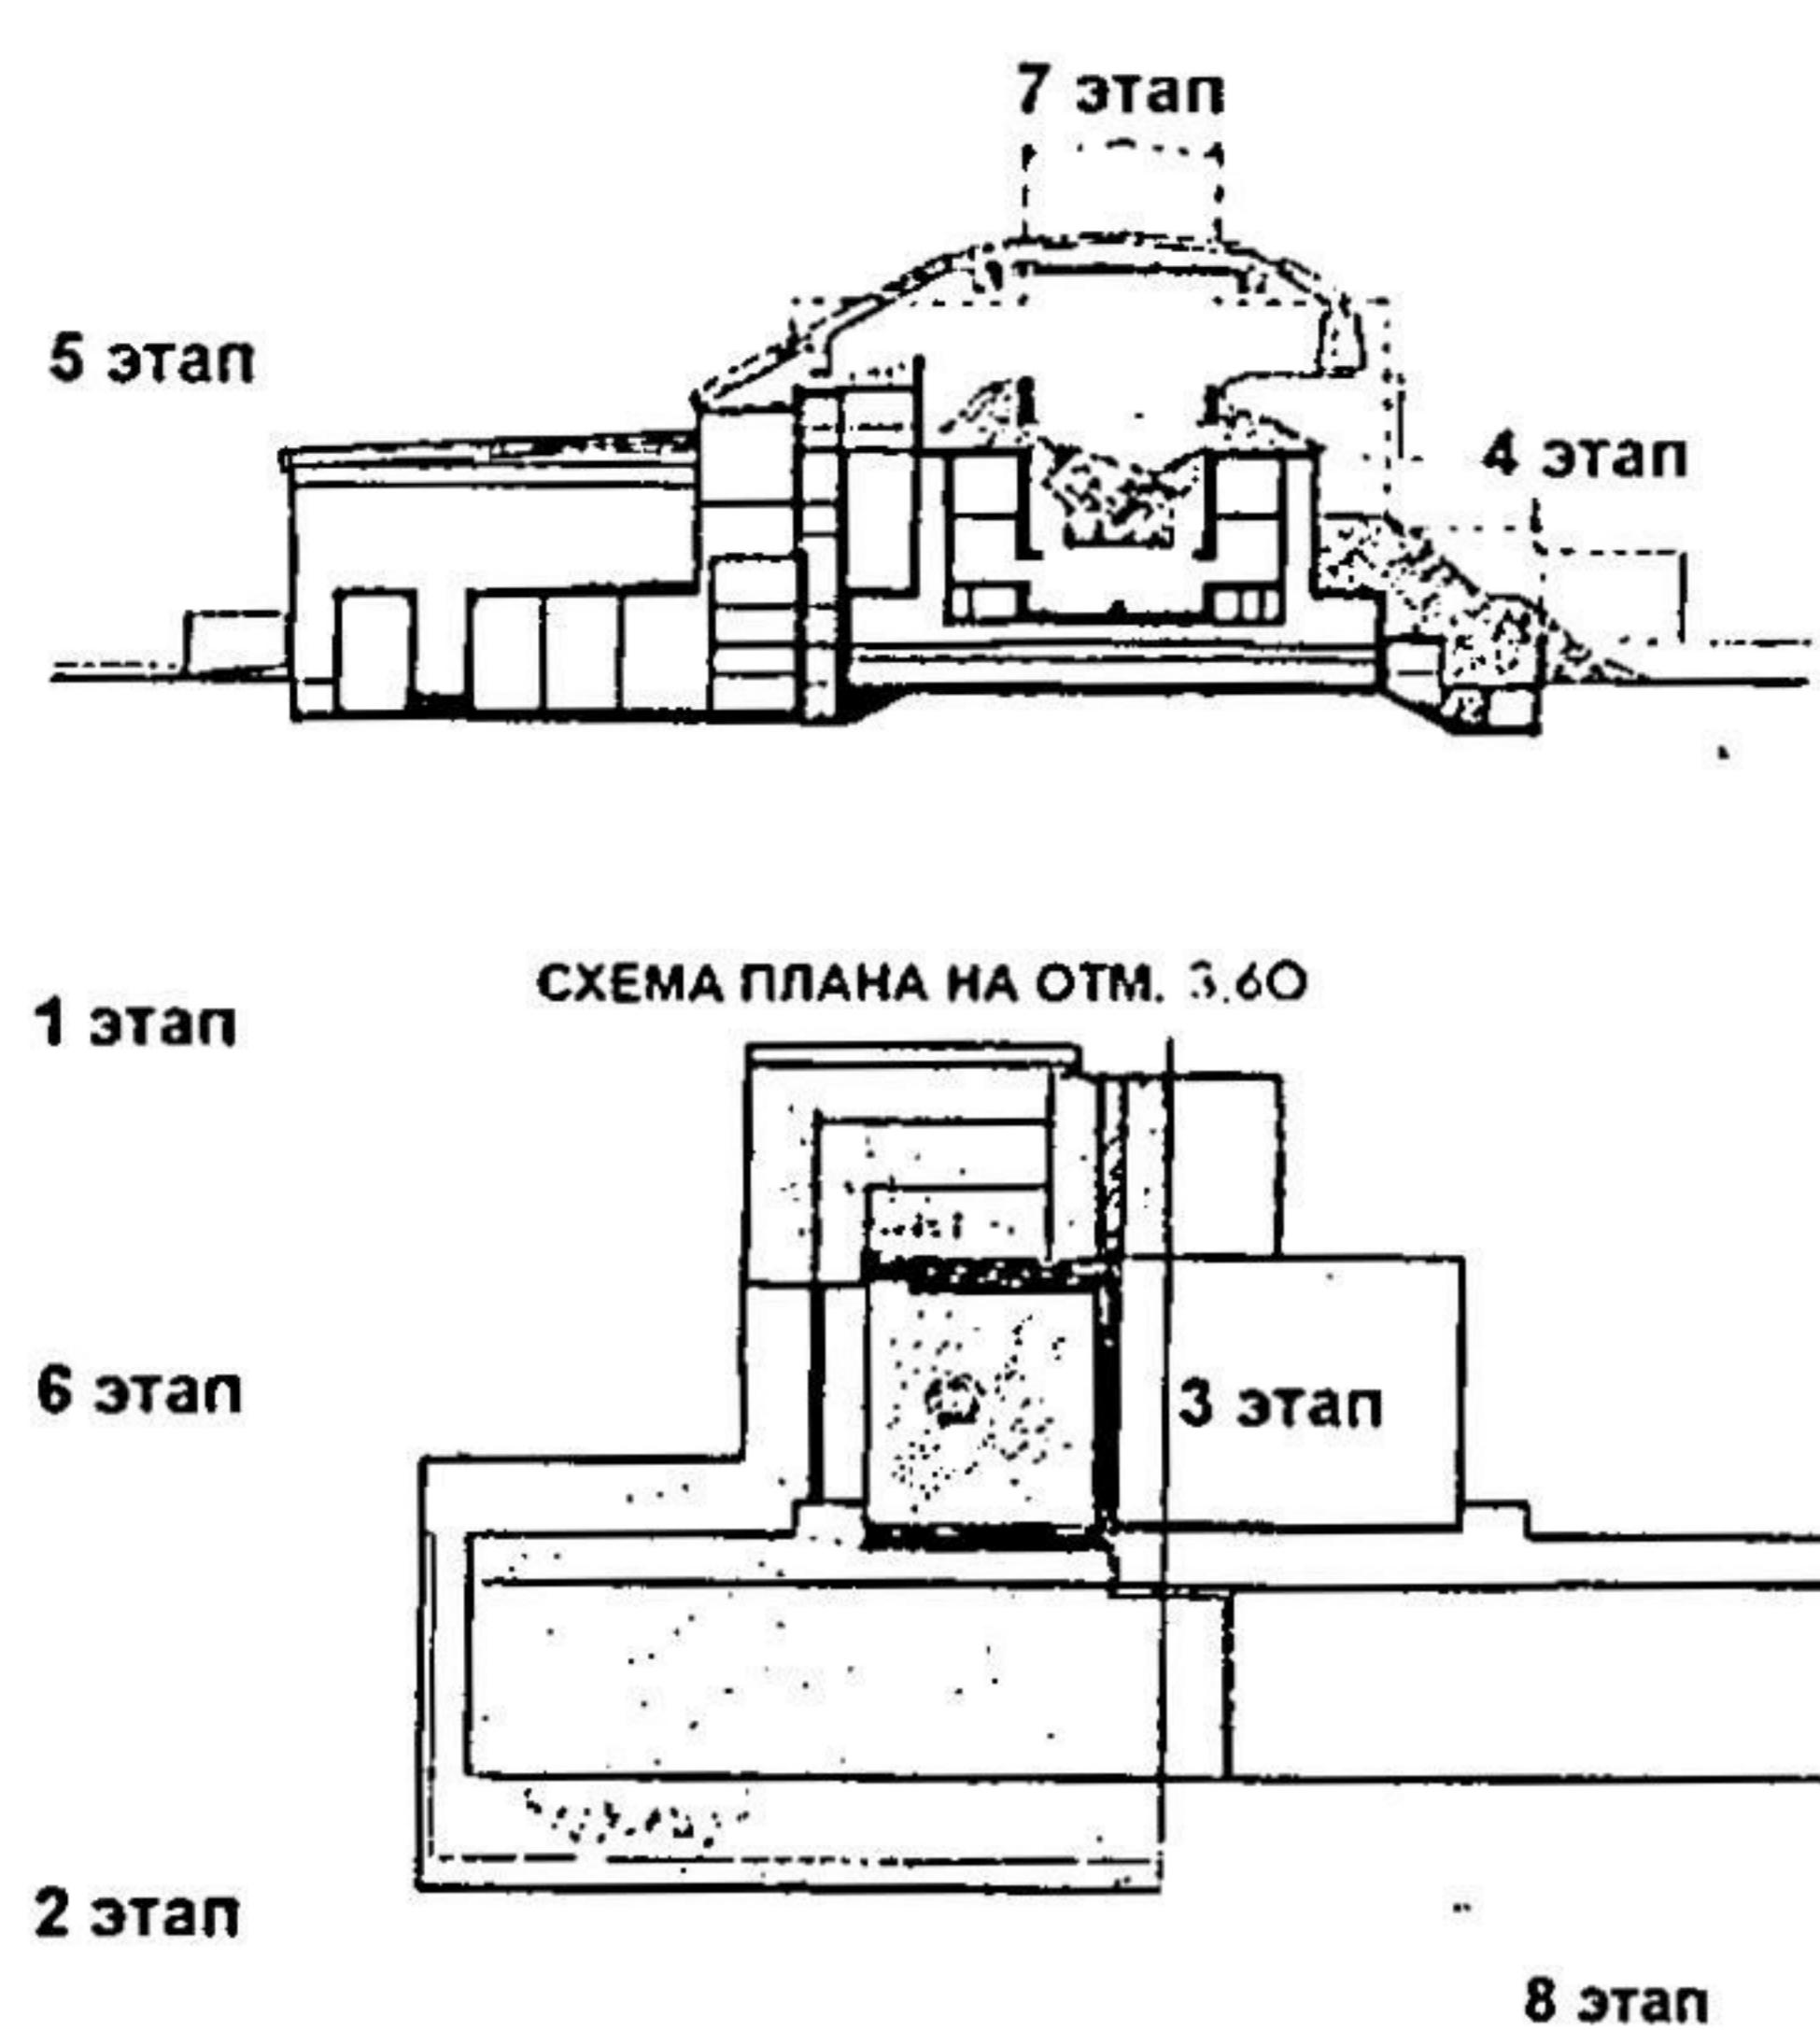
Этапы создания Саркофага: 1 – очистка и бетонирование территории вокруг 4 блока; 2 – возведение защитных стен по периметру; 3 – выполнение разделительных стен между 4 и 3 блоками; 4 – возведение каскадной стены; 5 – покрытие машзала; 6 – монтаж высотной контрфорсной стены; 7 – выполнение опор и монтаж покрытия реакторного блока; 8 – монтаж вентсистем и контрольно-измерительных коммуникаций и приборов
